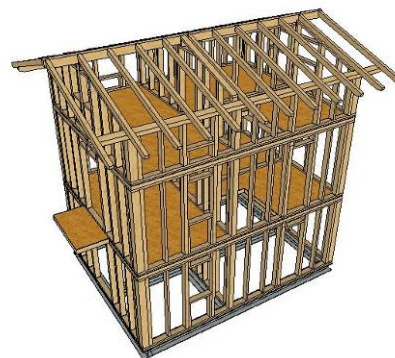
Vista tridimensionale dell'edificio senza la pannellatura strutturale
